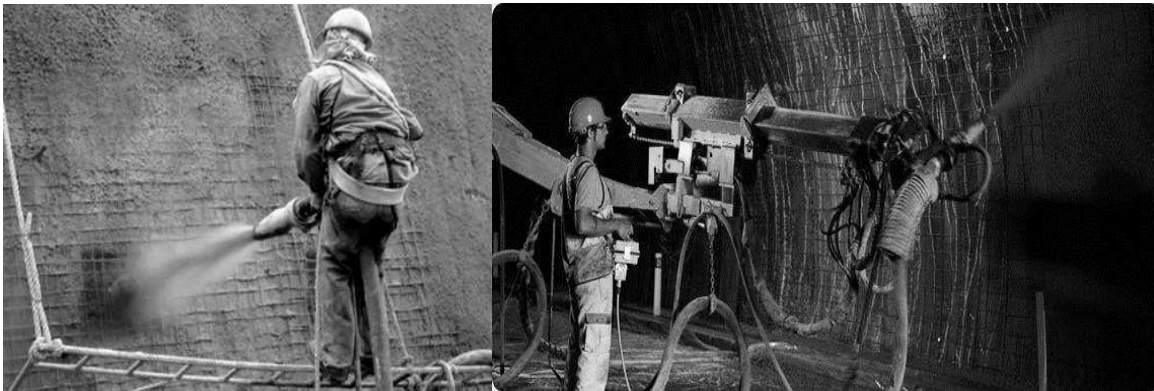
Concreto lanzado sobre mallas metálicas.
